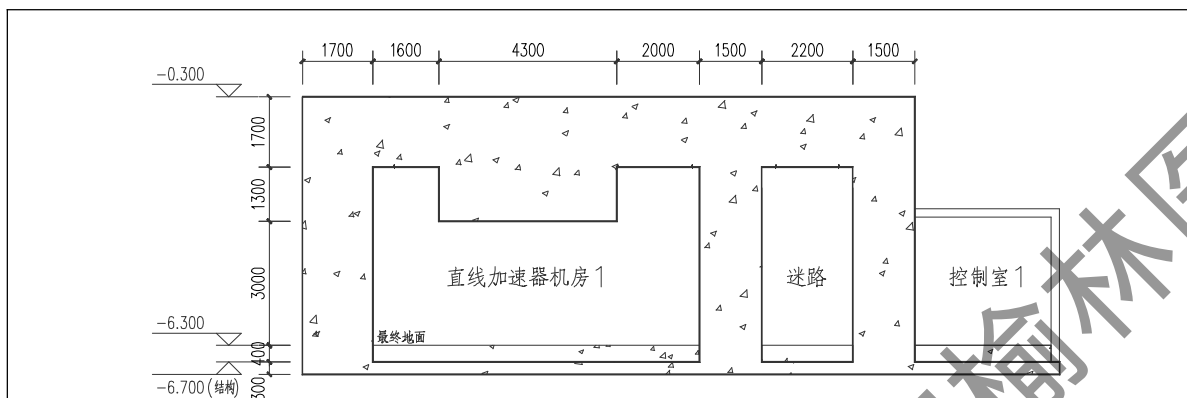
直线加速器机房B-B剖面图 (单位: mm)
